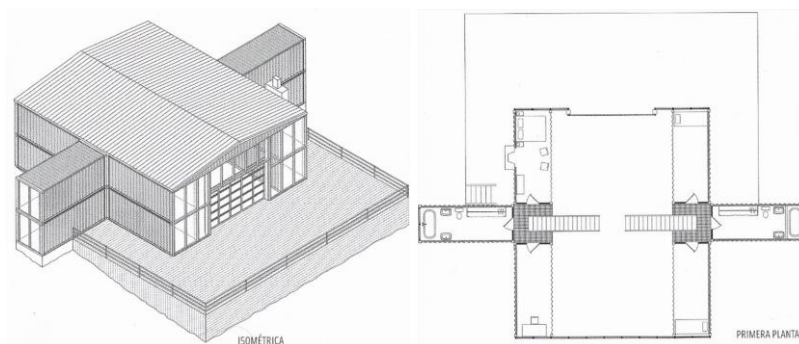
12 *Container House* del Arq. Adam Kalkin, isometría y primera planta. Kotnik (2013).
